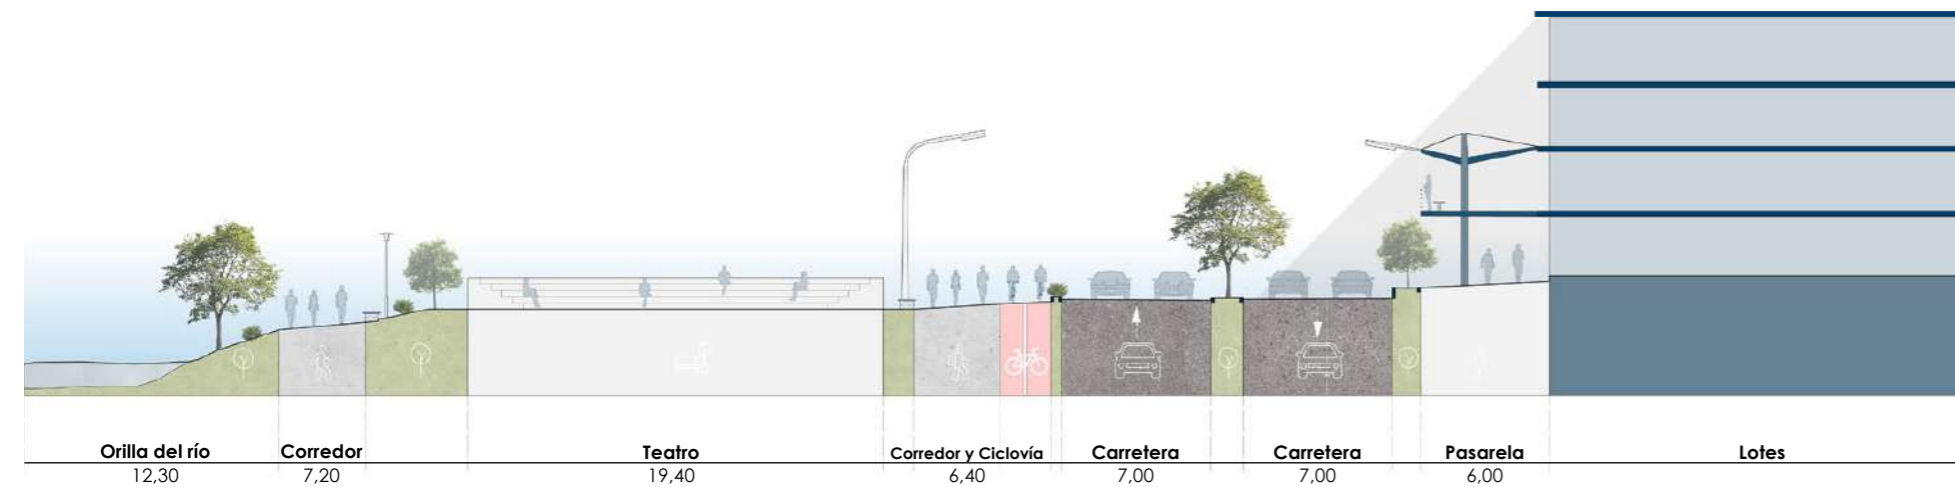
Sección vial (Tramo 30-45m). Fuente: Autoría propia (2026)
